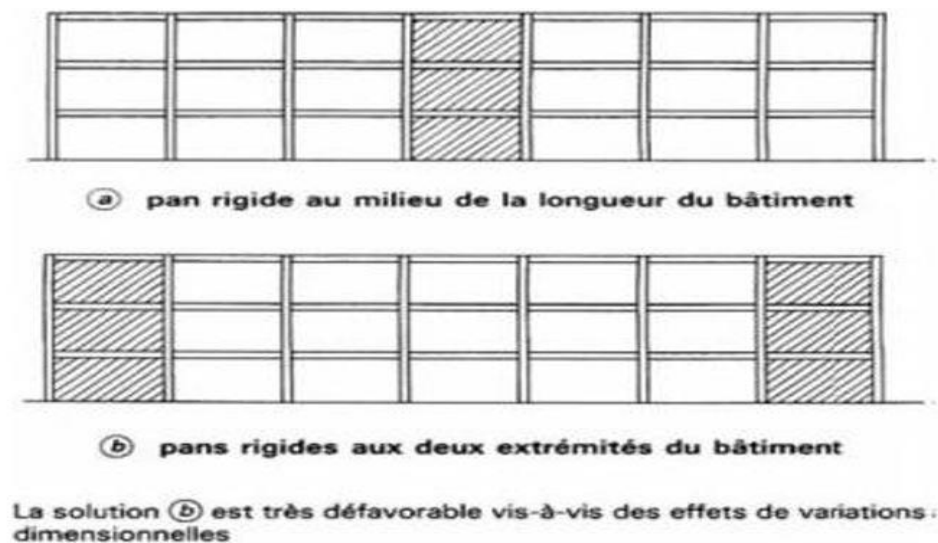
Contreventement longitudinal d'un bâtiment. Disposition des pans rigides [12]
